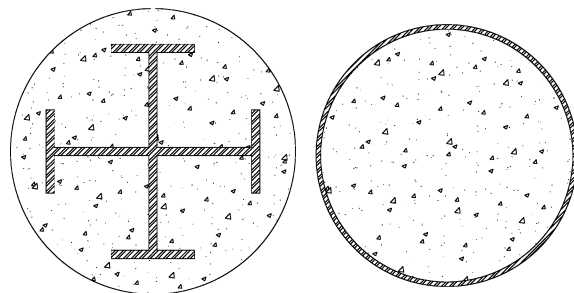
钢管混凝土柱与型钢混凝土柱截面对比
